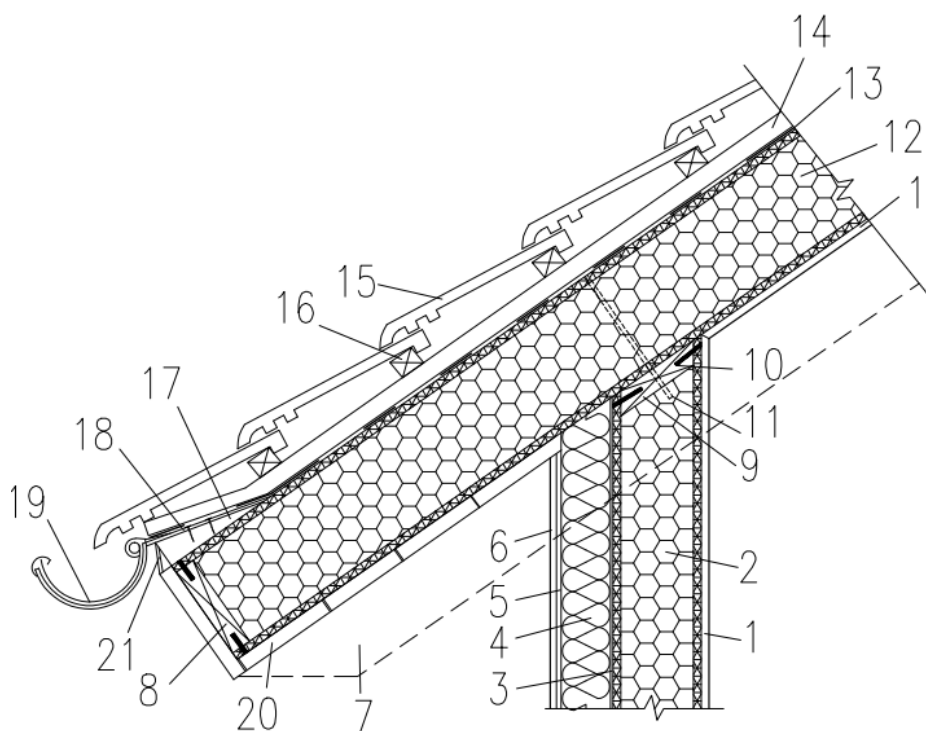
Detail napojení stropní konstrukce na obvodovou stěnu
